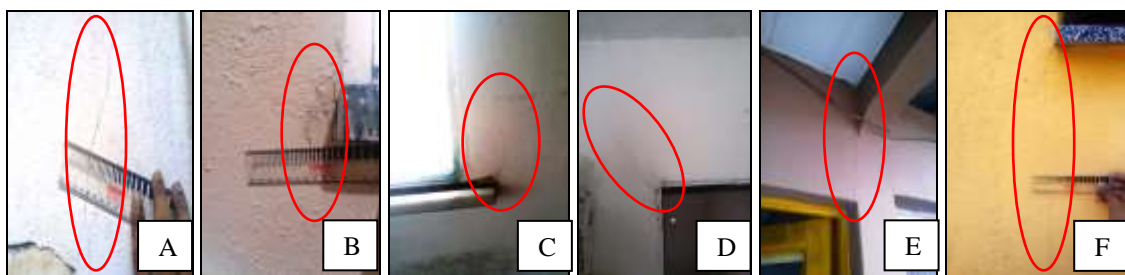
Fissurações nas aberturas de esquadrias das edificações em estudo: (A) Porta de acesso ao pavimento superior da Edificação 1; (B) Janela da suíte 1 da Edificação 2; (C) Janela da sala da Edificação 3; (D) Porta da cozinha da Edificação 4; (E) Porta da cozinha da Edificação 5; (F) Janela da entrada da Edificação 6
